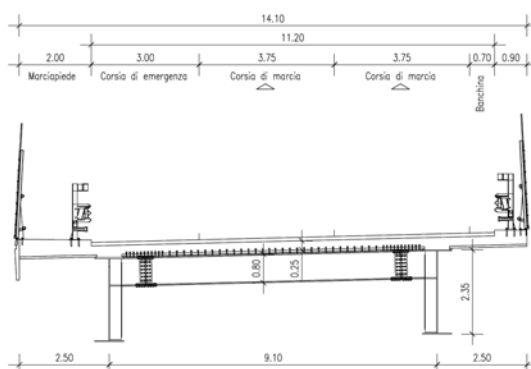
sezione tipologica dell’impalcato a struttura mista acciaio calcestruzzo per una carreggiata
